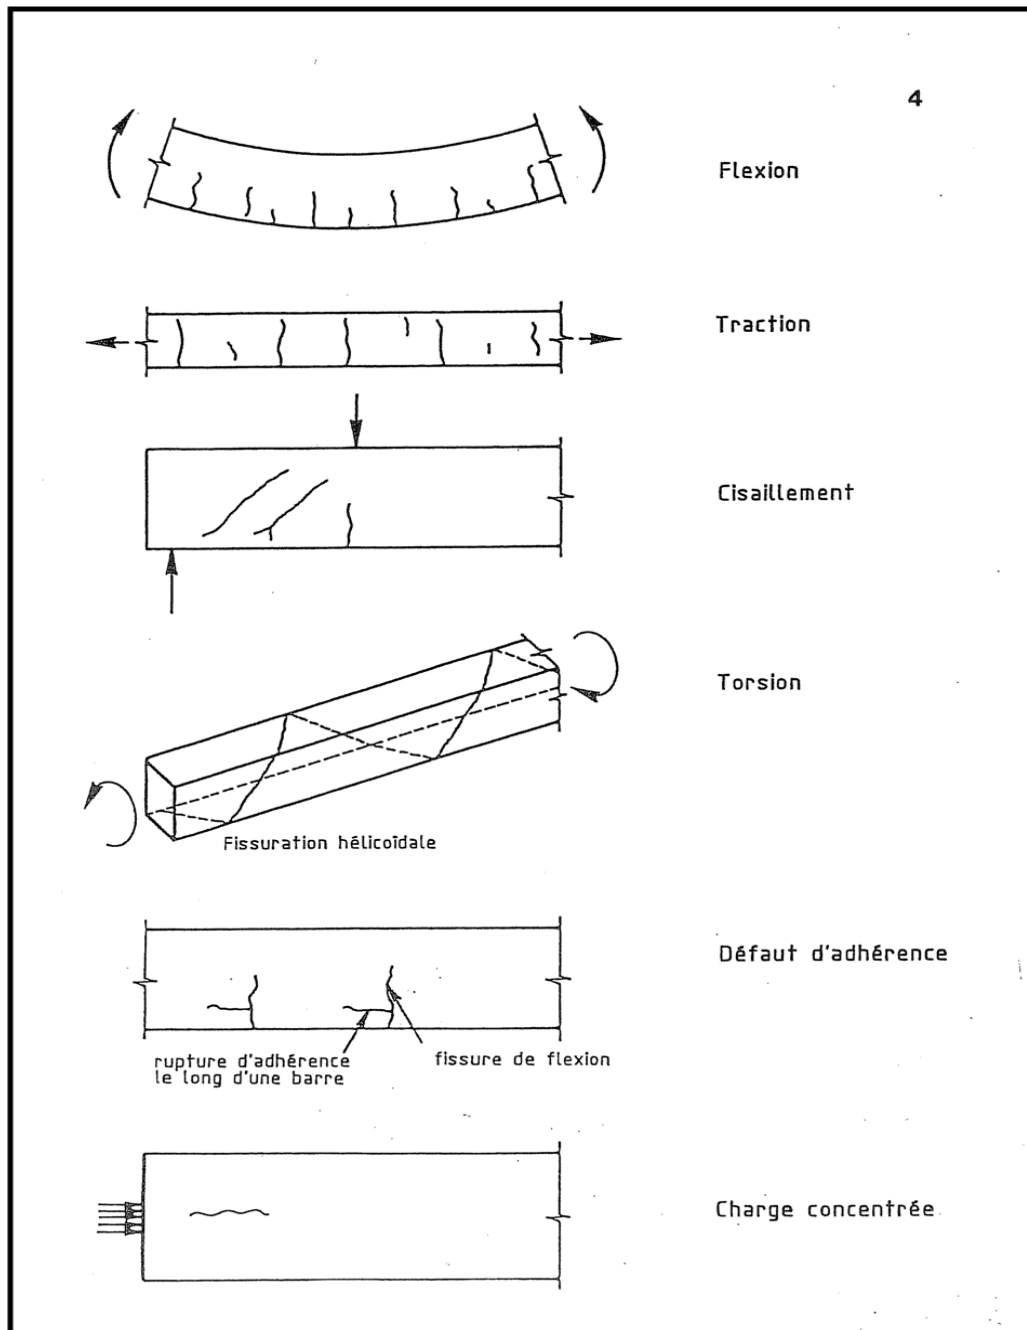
Fissurations mécaniques typiques d'éléments en béton armé.
